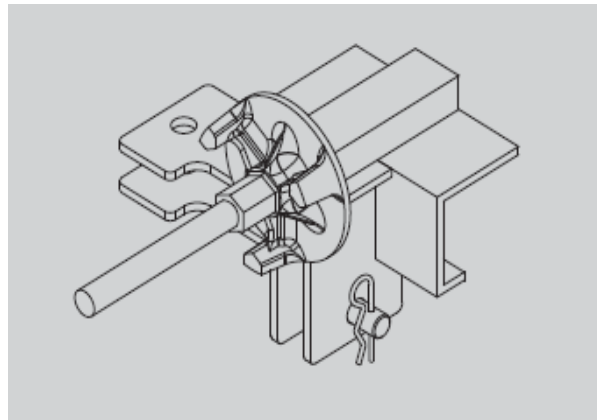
Cabezal. Recuperado de: Ulma Construction, *Catálogo encofrado modular ORMA 60*.
